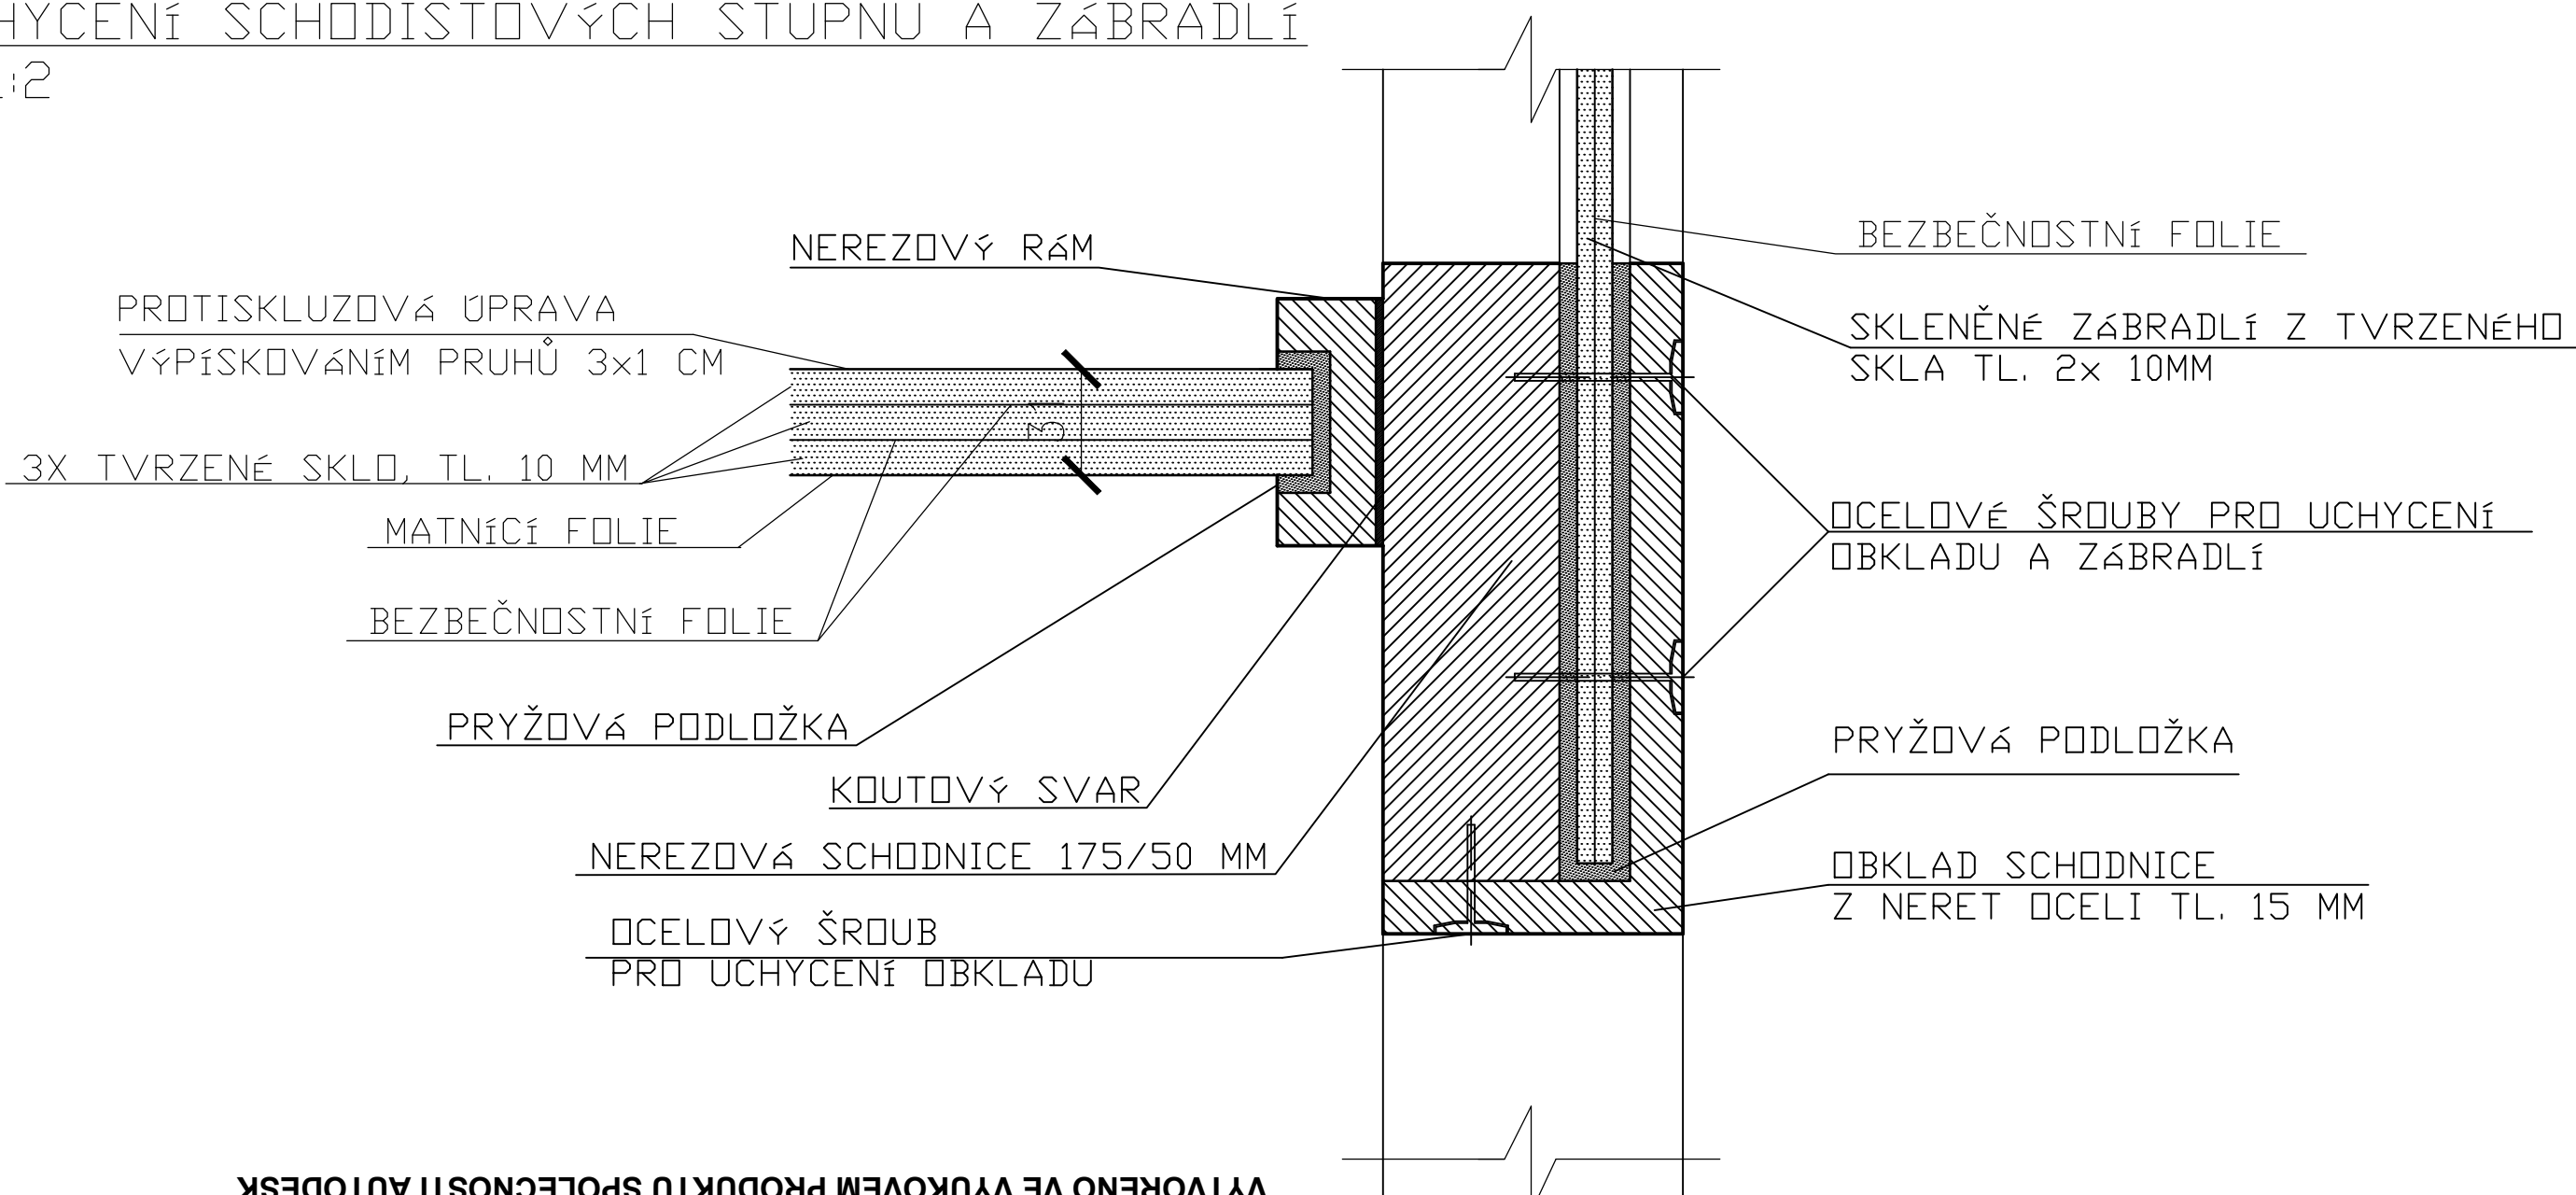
DETAIL ULOŽENÍ SKLENĚNÝCH STUPŇŮ DO STĚNY M 1:2
